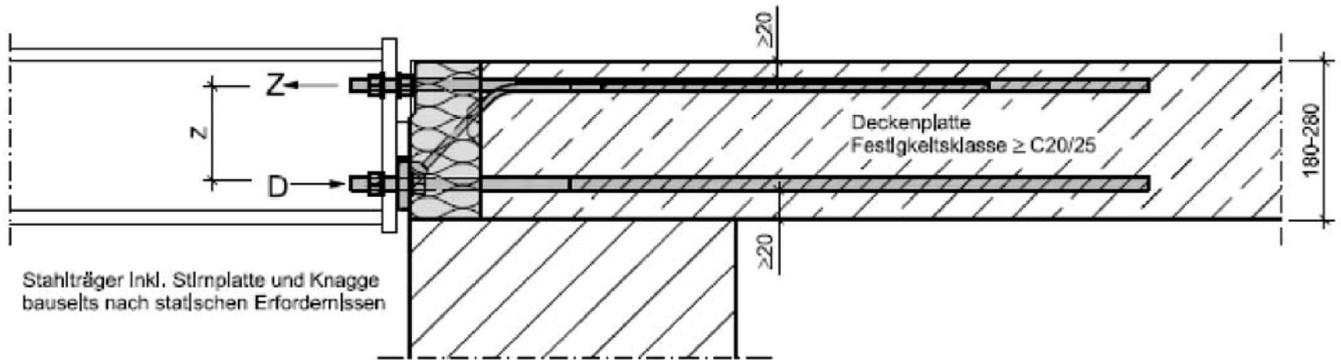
Schöck Isokorb® T Typ SK-MM1-VV1
